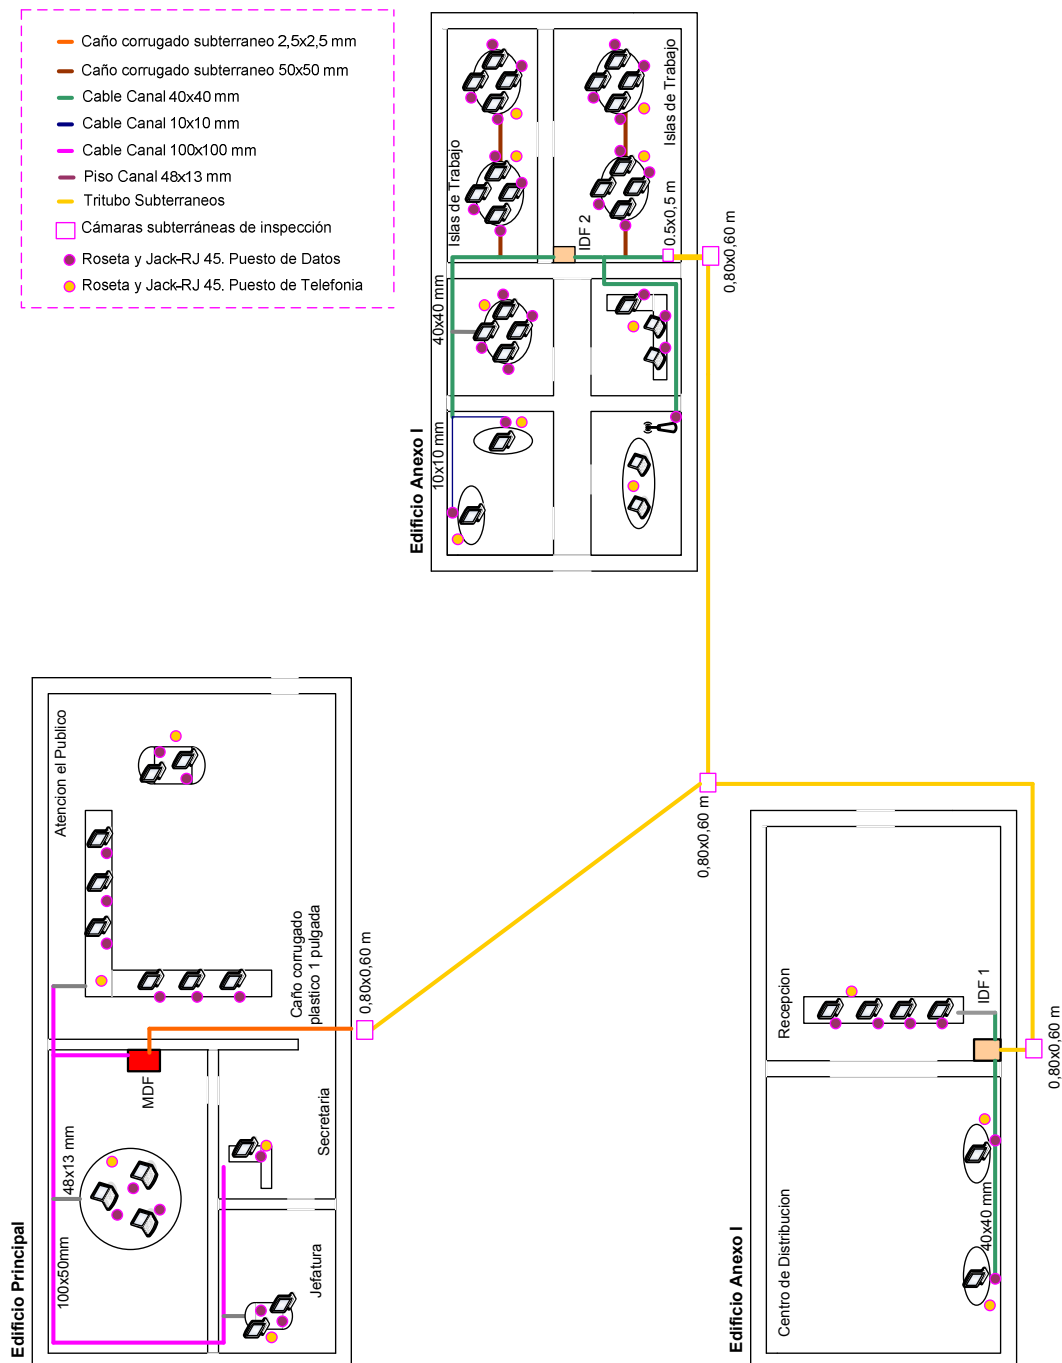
Ejemplo sistema de cableado estructurado
